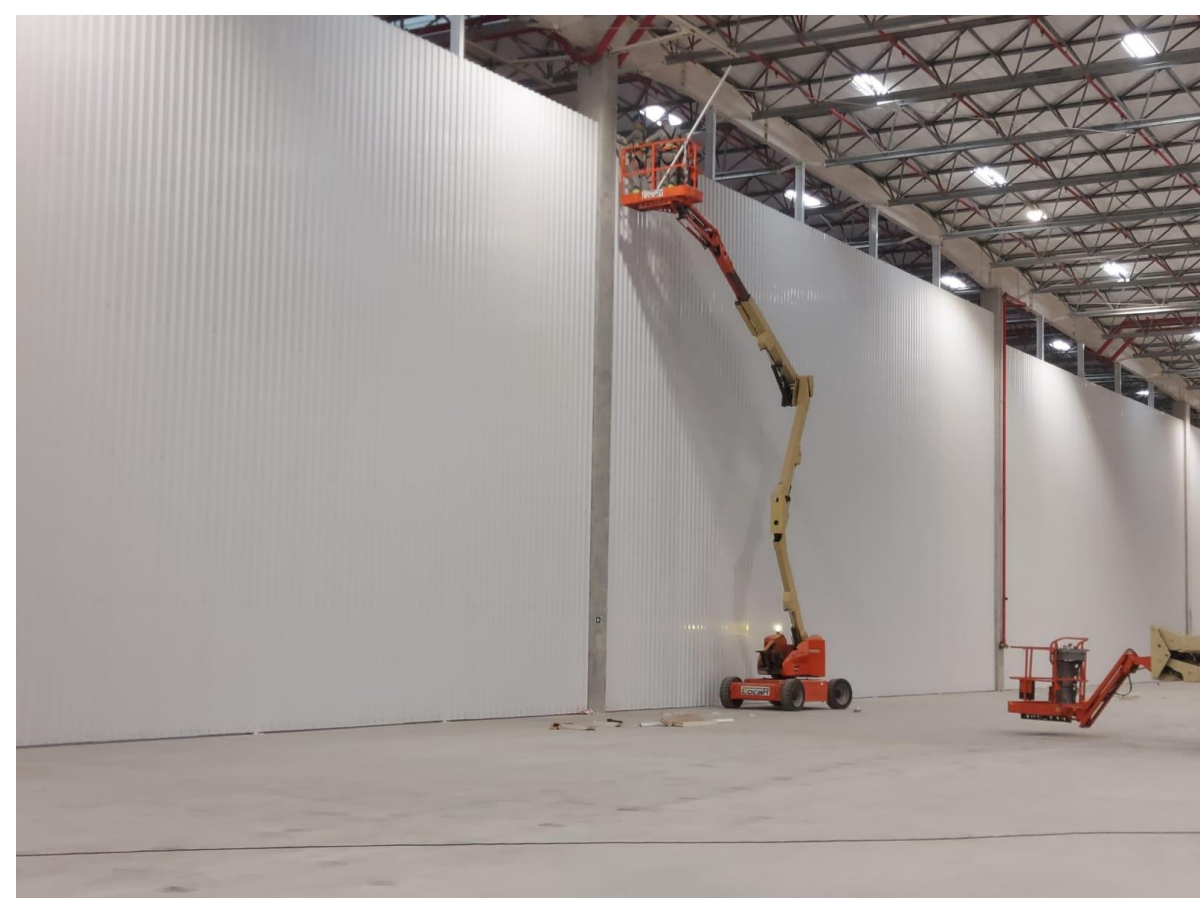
finalização do fechamento da divisória metálica entre os módulos
